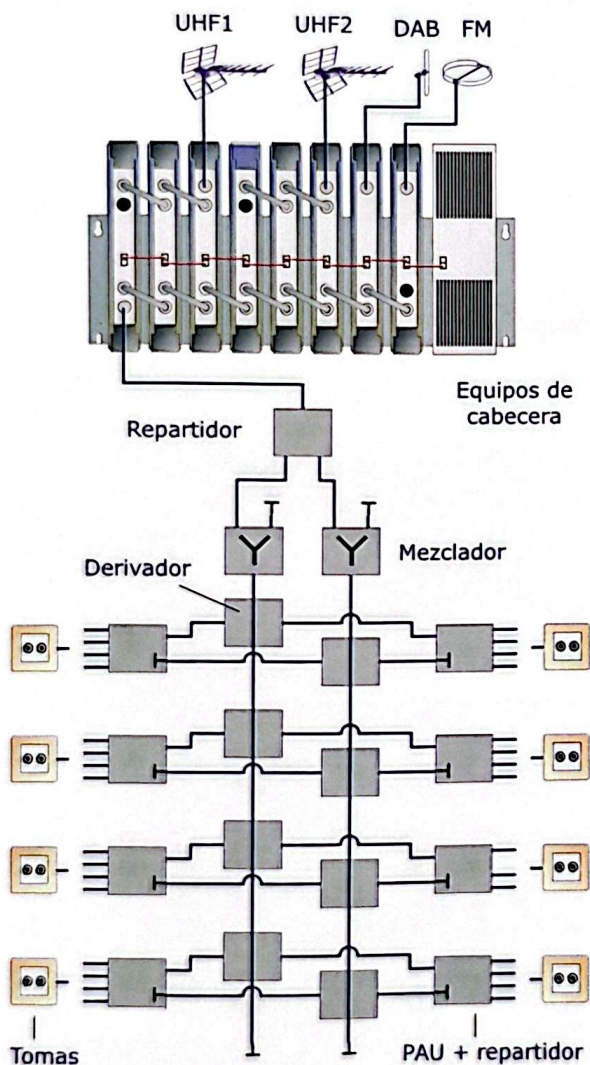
Instalación colectiva con una bajante y preparada para SAT.
